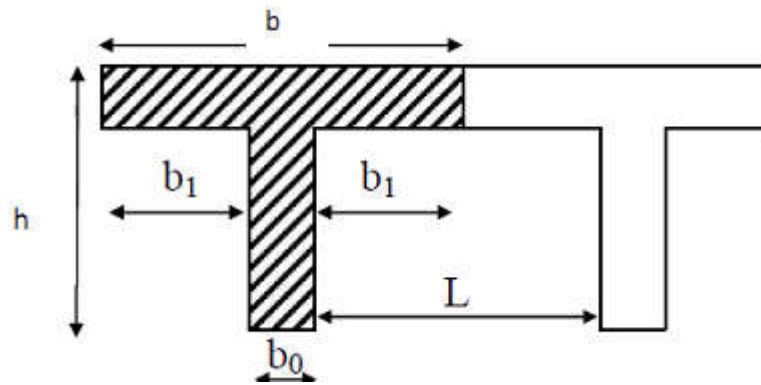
Section de la poutrelle après coulage de la dalle de compression.
